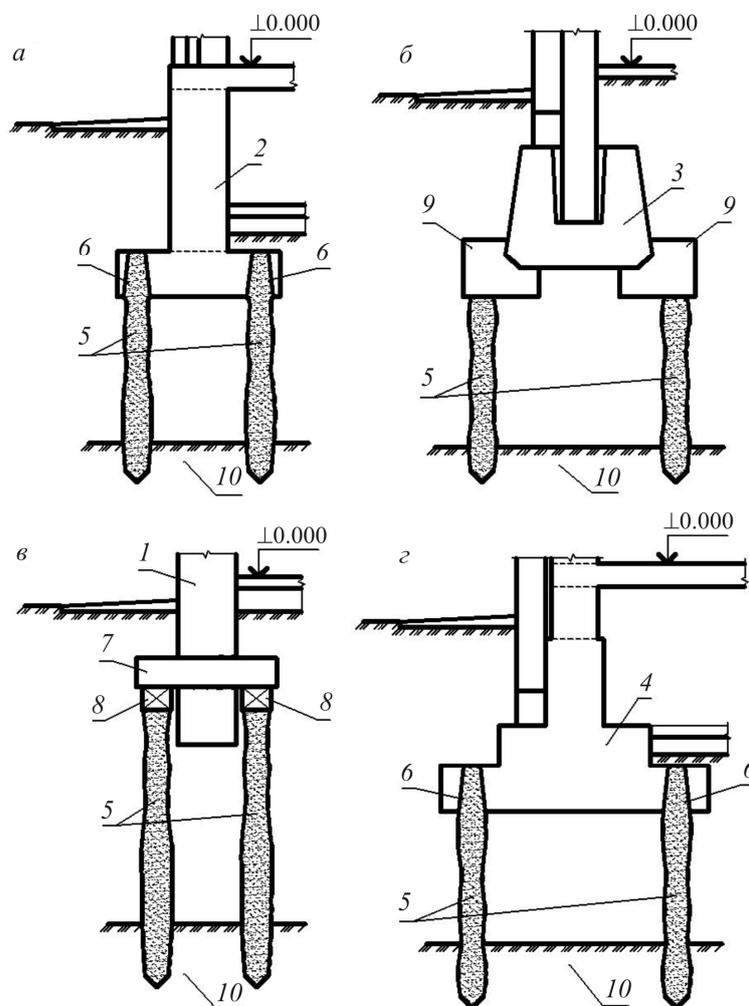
Способы передачи дополнительной нагрузки на сваи при усилении фундаментов реконструируемых зданий: а, в – ленточных; б, г – отдельных; 1 – существующий ленточный бутовый (кирпичный) фундамент; 2 – существующий ленточный монолитный железобетонный фундамент; 3 – существующий отдельный сборный железобетонный фундамент; 4 – существующий отдельный монолитный железобетонный фундамент; 5 – инъекционная свая; 6 – конусовидное отверстие в плитной части существующего фундамента; 7 – поперечная металлическая балка, устраиваемая через отверстие в стеновой части существующего фундамента; 8 – продольная железобетонная балка; 9 – железобетонная обойма, устраиваемая по периметру фундамента; 10 – несущий слой прочного (малосжимаемого) грунта
